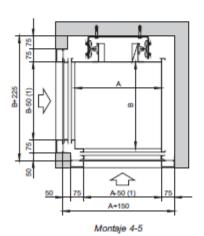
Dimensiones en Planta. Tipo de Instalación: Fijación a Muro.
